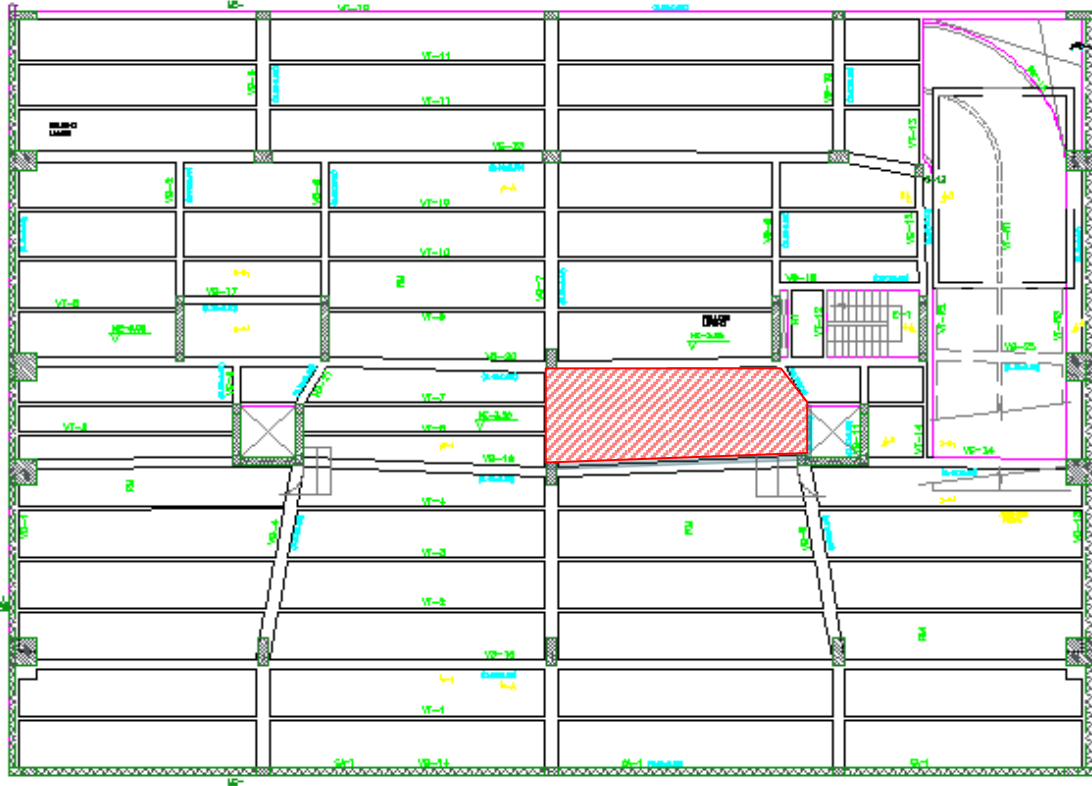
Vista en planta del entrepiso y panel de estudio
